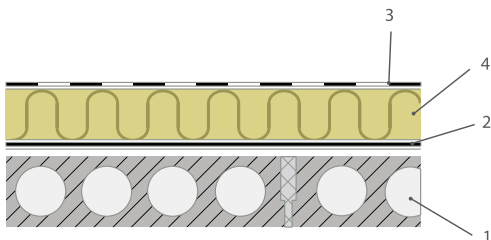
Утепление чердака при плитном и балочном чердачных перекрытиях:
